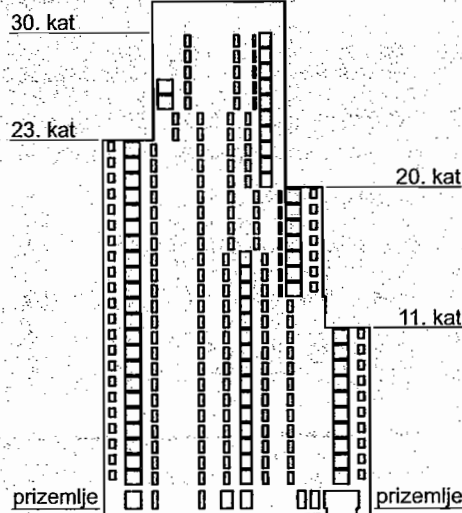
Konstrukcija Zürich Hochhausu u Frankfurtu
